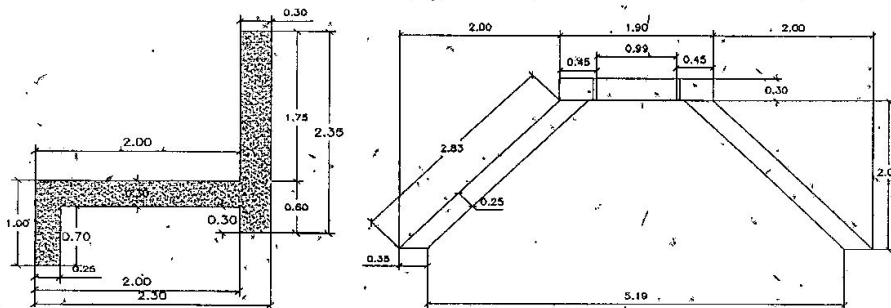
Vista del alzado del Encole y Planta del Encole y Descote. Fuente: Diseños entregados por el solicitante.
